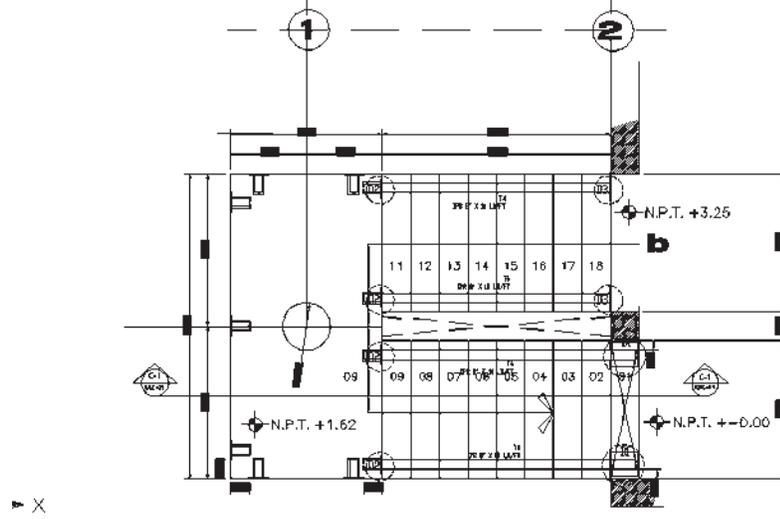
18.- Planta de escalera de planta baja a primer nivel.
